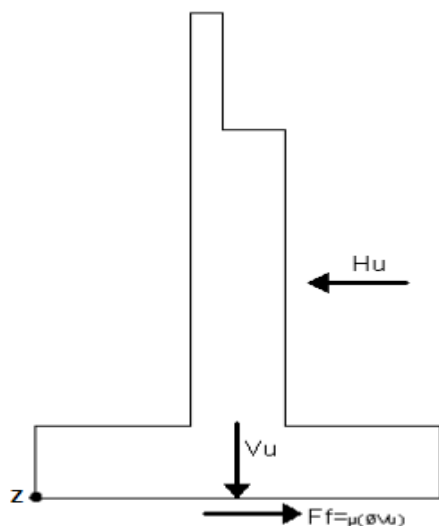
Carga que actúa en la de la base de estribo por deslizamiento. Elaborado por: Autor
